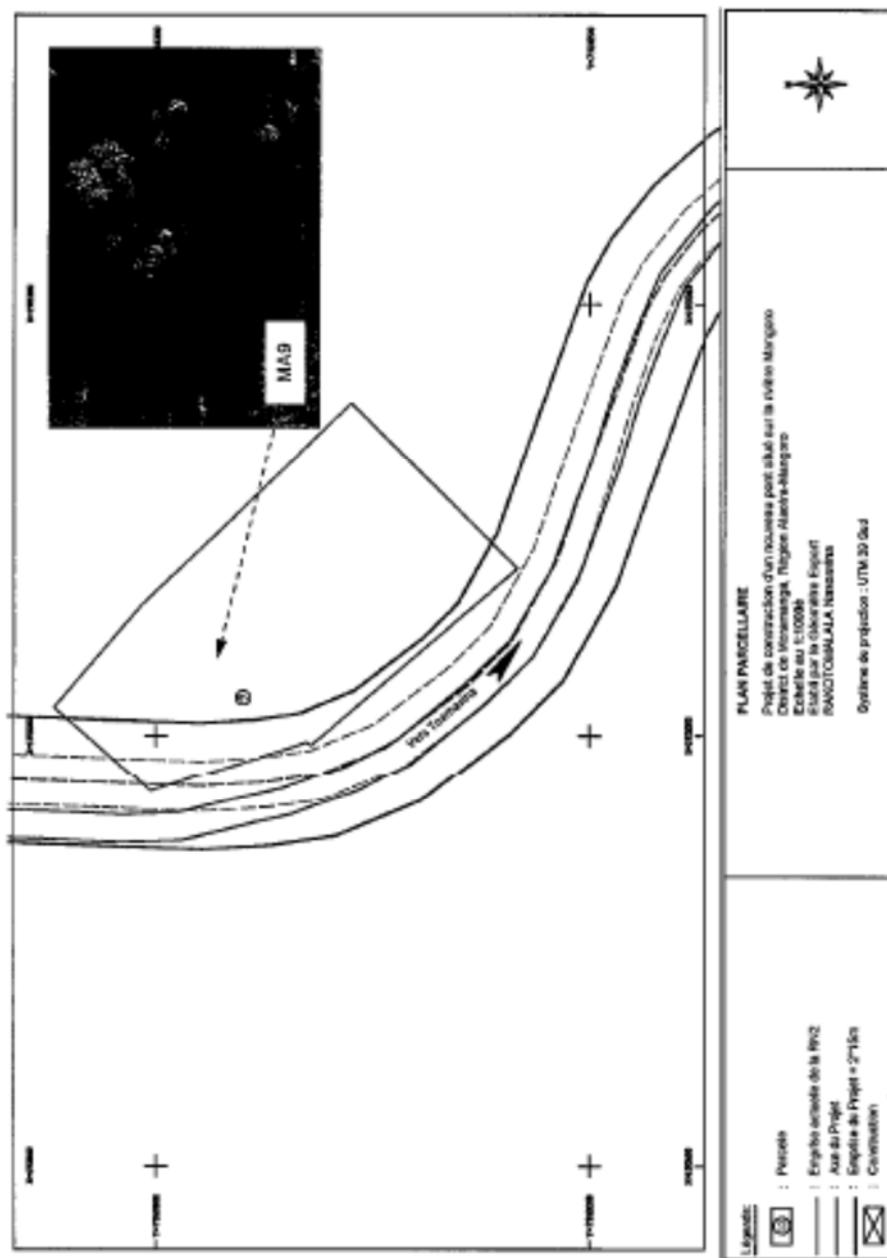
PLAN PARCELLAIRE – MANDORO 3
